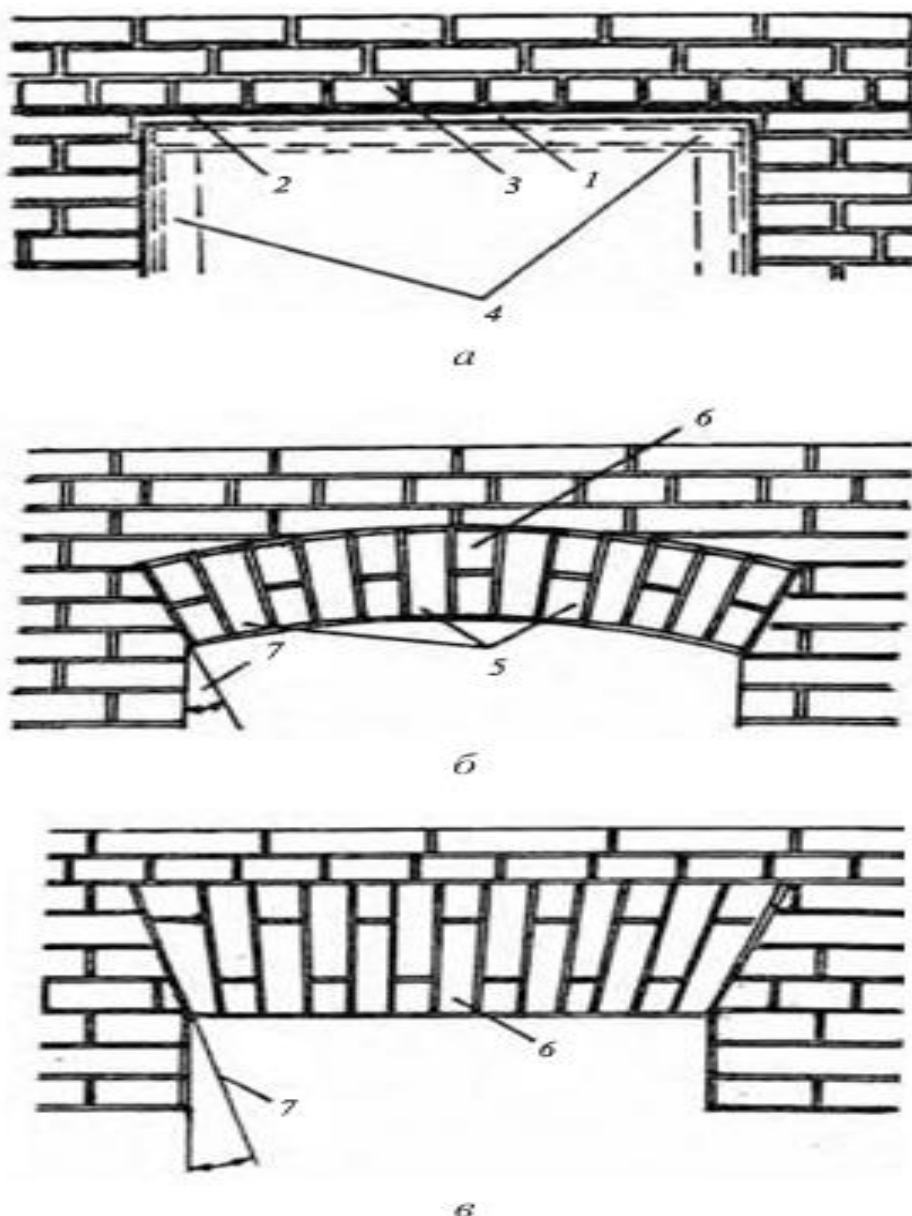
Перемычки из кирпичной кладки: а — рядовая; б — арочная; в — клинчатая: 1 — 4 см слоя раствора; 2 — арматура; 3 — кладка; 4 — опалубка; 5 — кладка арки; 6 — замковые кирпичи; 7 — угол кладки кирпичей
